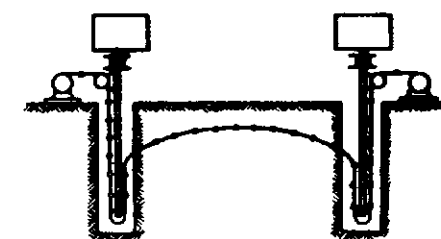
Schița instalației folosită la executarea ecranelor impermeabile din argile tixotrope.
